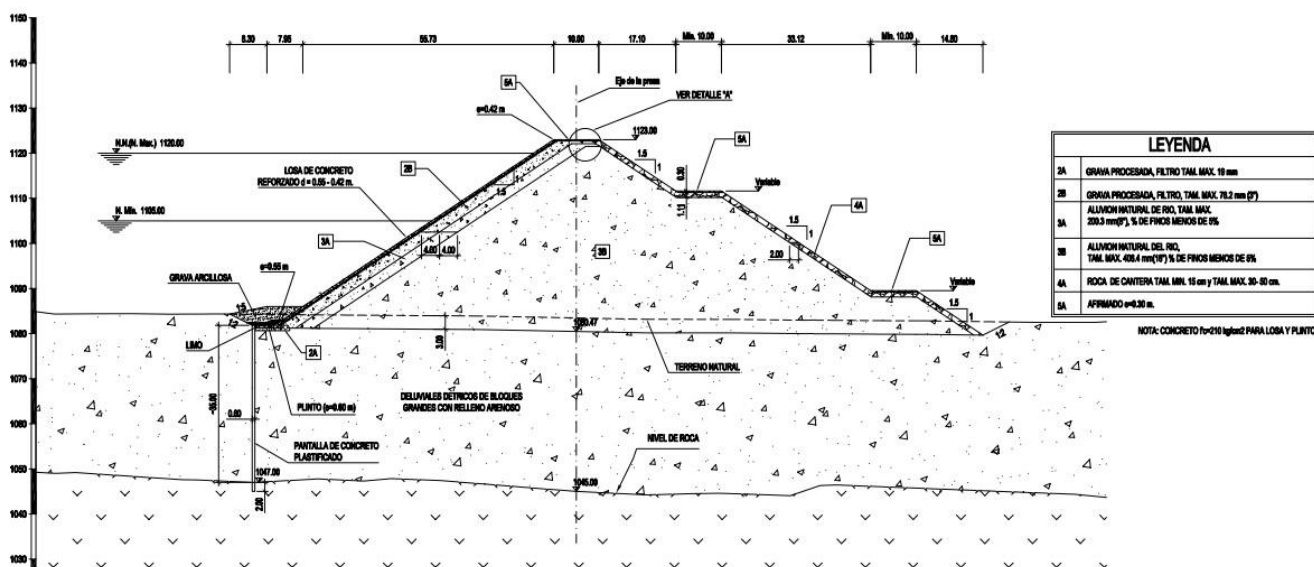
Sección típica 2-2 de la presa. Fuente: Elaboración propia
